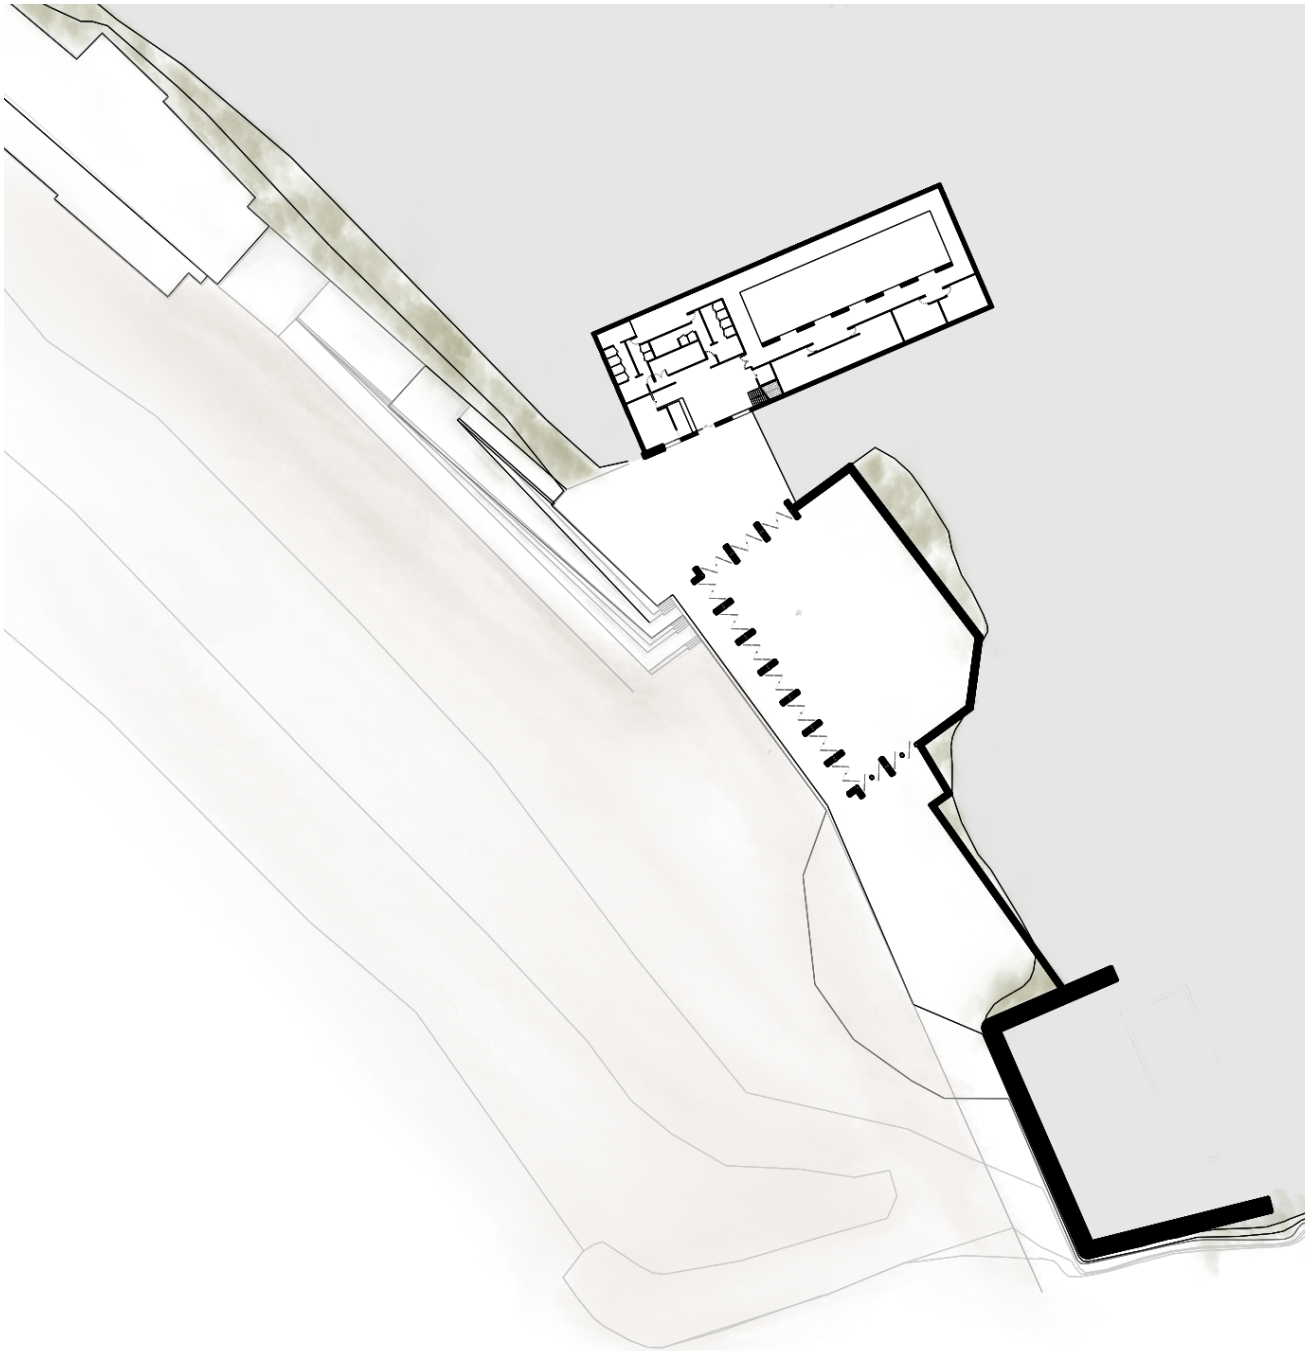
12 | Planta do segundo piso do núcleo desportivo - conexão com o espaço público.
